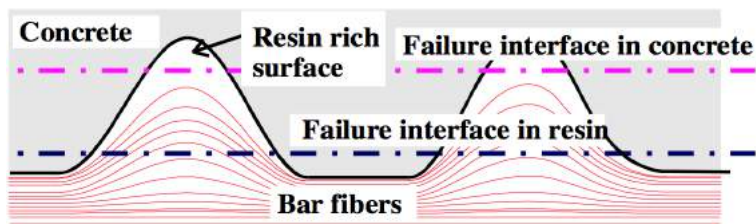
Fallo en la interfaz entre hormigón y armadura de barras FRP (Achillides et al., 2004).
